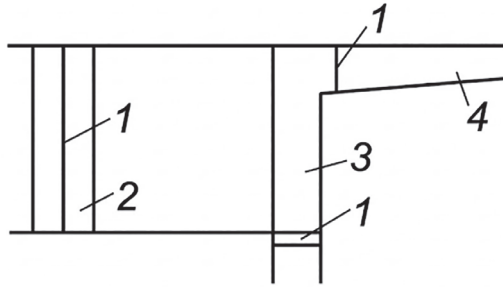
Esquema de ubicación en planta de las juntas de deformación en el caso de un muro con paredes de retorno.
